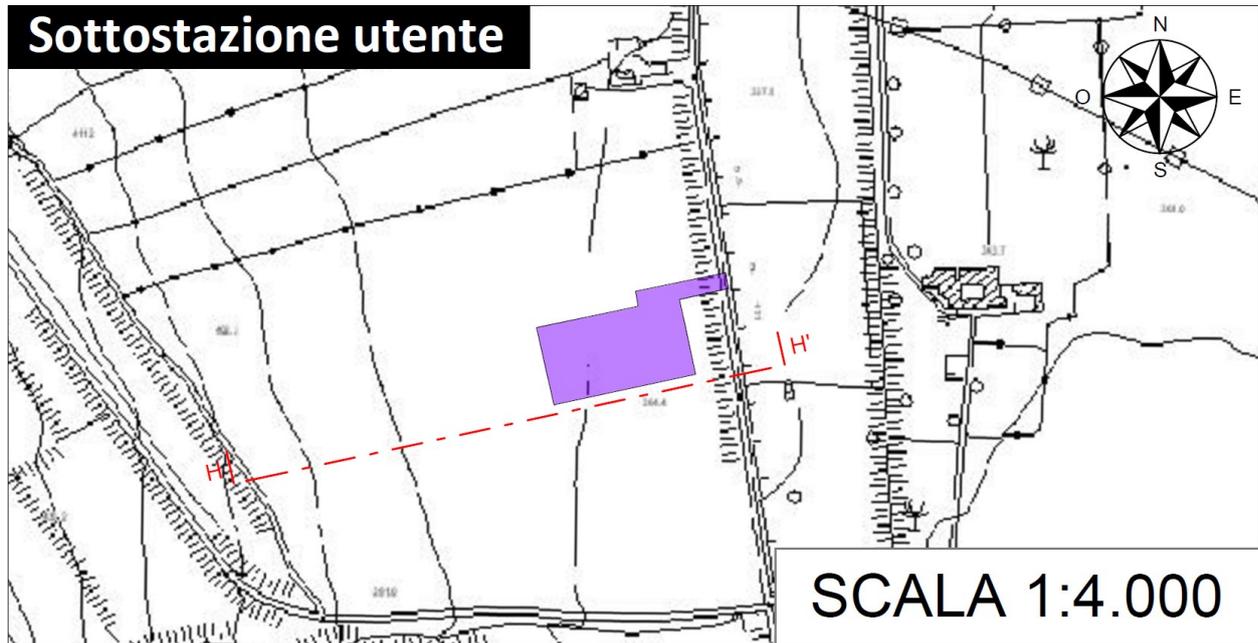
Planimetria e indicazione della sezione – Sottostazione utente
